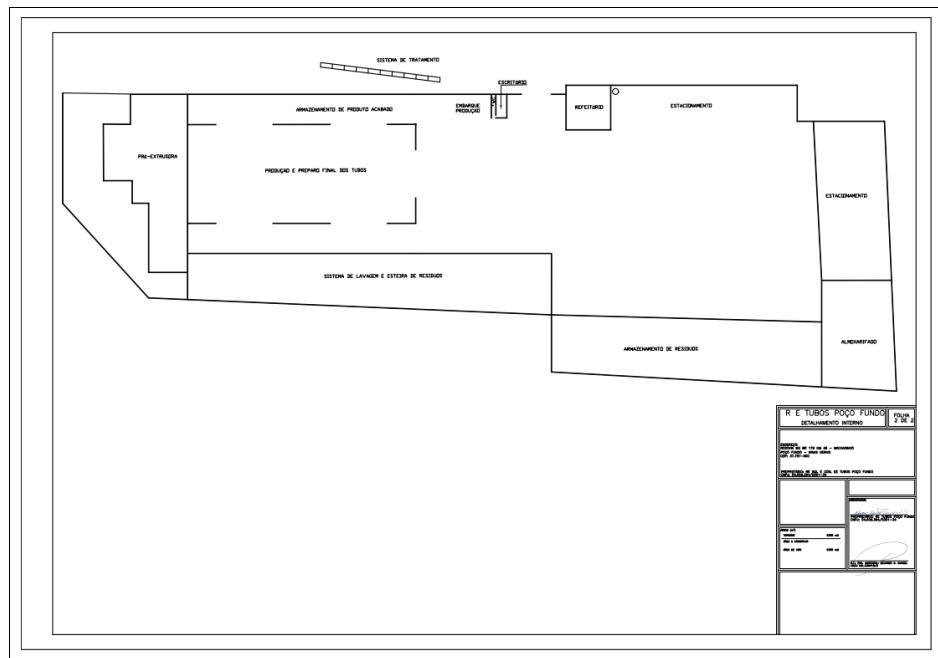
Planta de uso e ocupação do empreendimento. *Fonte:* SLA
